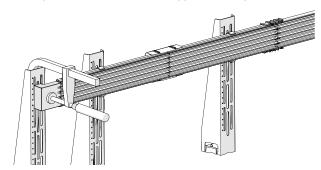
Fixer le bloc de montage (n° de commande : 08-V015-0492-00x) avec un serre-joint.
